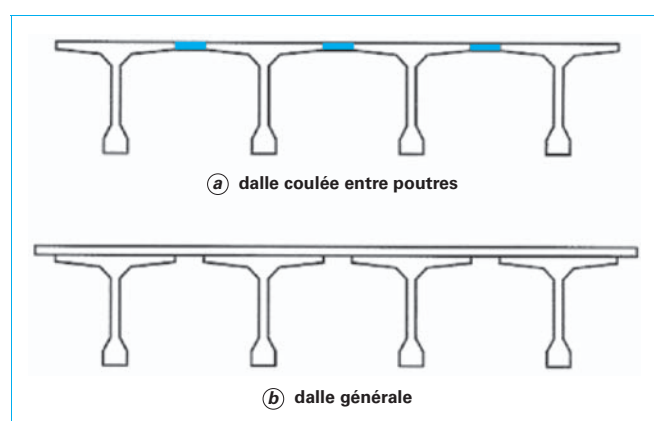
Conceptions possibles d'un tablier de pont à poutres précontraintes par post-tension
